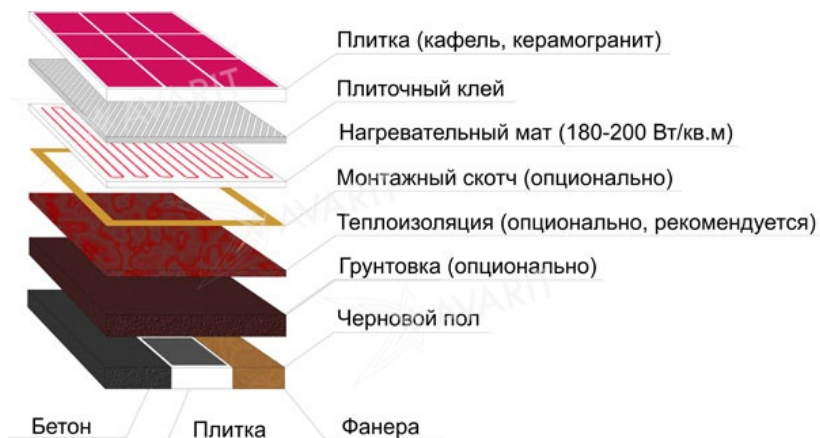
Установка нагревательного мата под плитку (основное отопление или на веранде, в гараже, на балконе)
